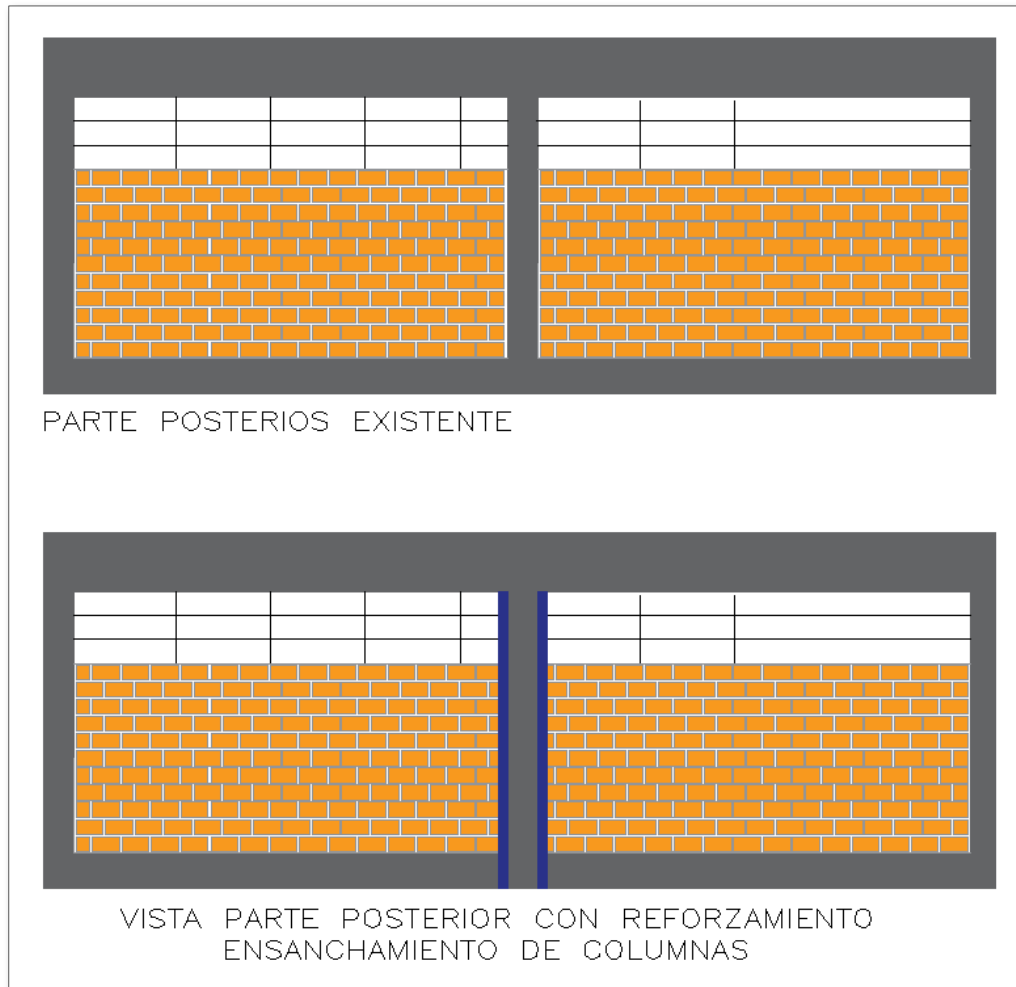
Plano del 1° y 2° piso del pabellón B con la propuesta adición y ensanche de columnas.
